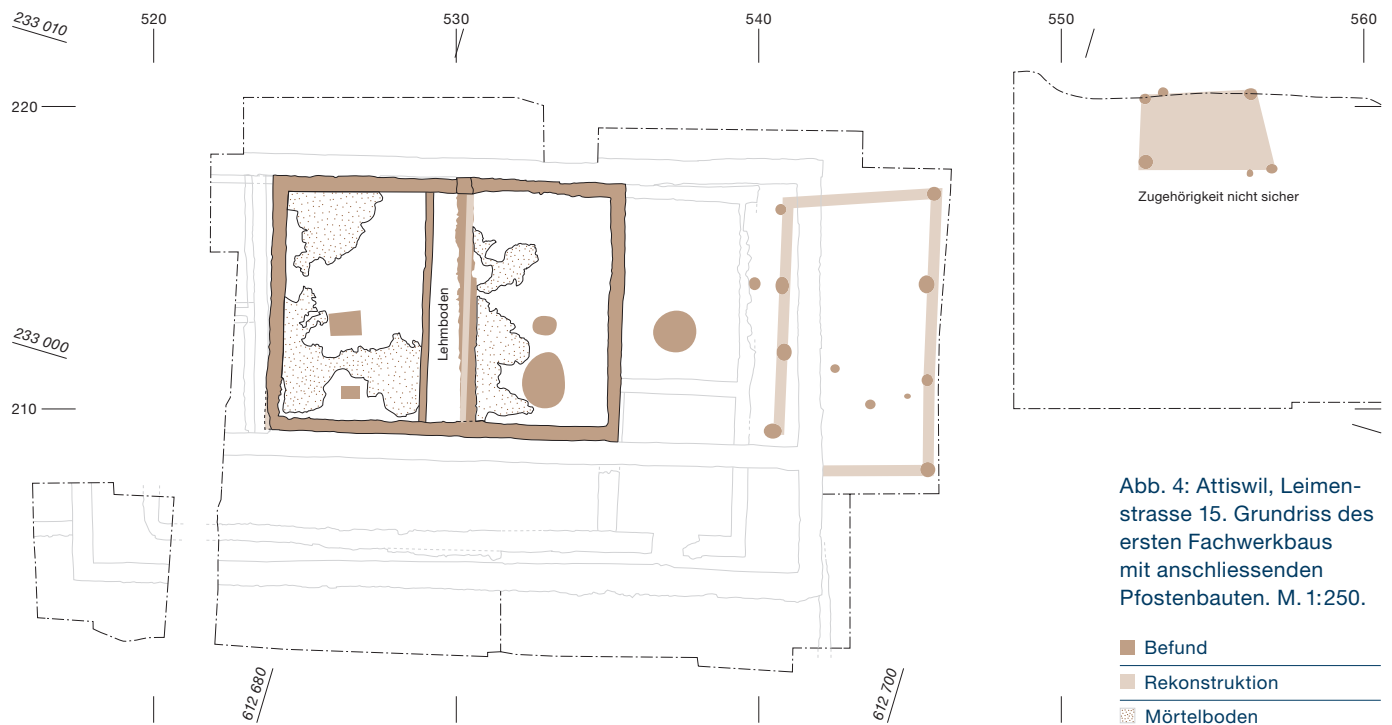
Attiswil, Leimenstrasse 15. Grundriss des ersten Fachwerkbaus mit anschliessenden Pfostenbauten. M. 1:250.
